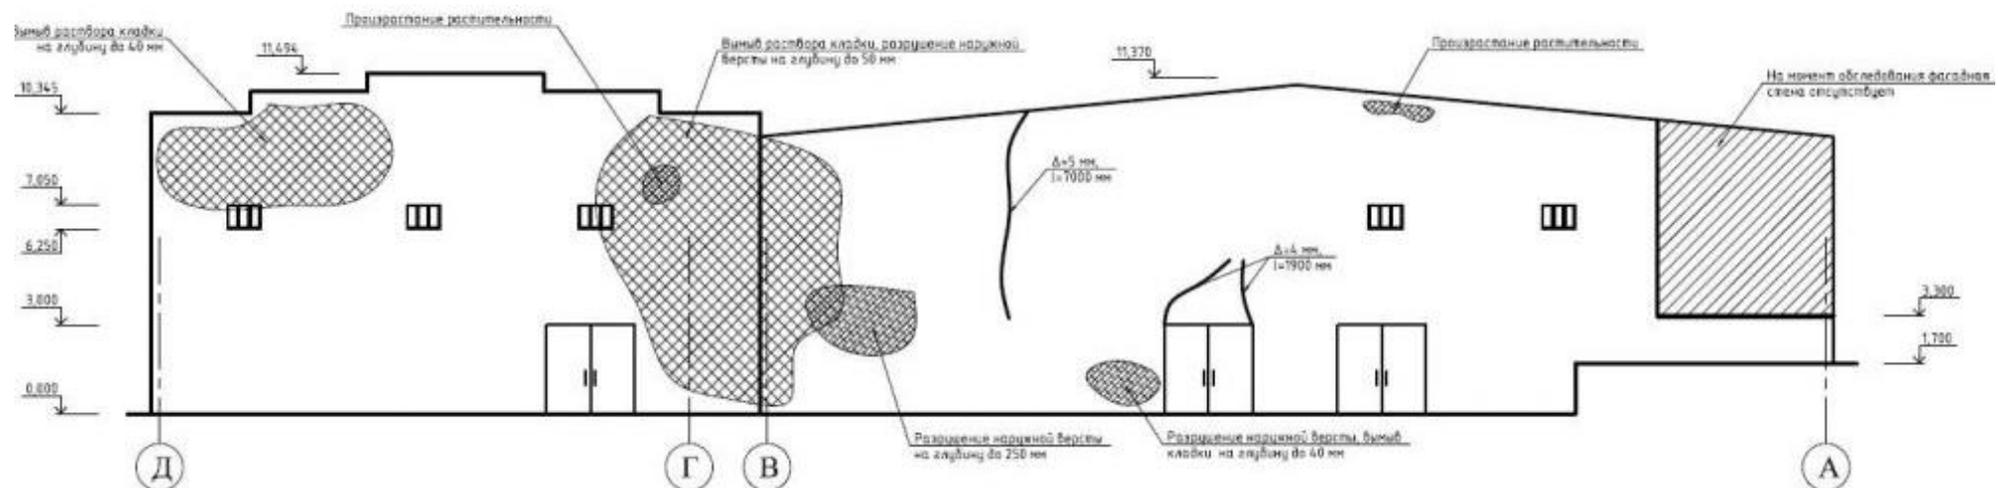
Пример схемы расположения дефектов на фасаде здания
